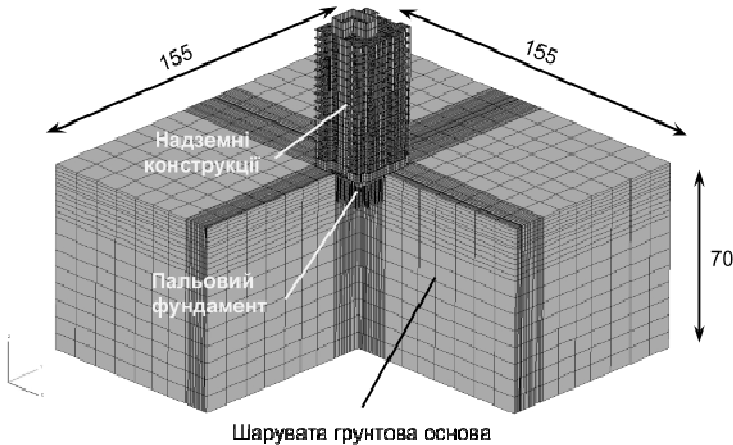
Скінченно-елементна модель будівлі, як системи "основа – фундамент – будівля"
